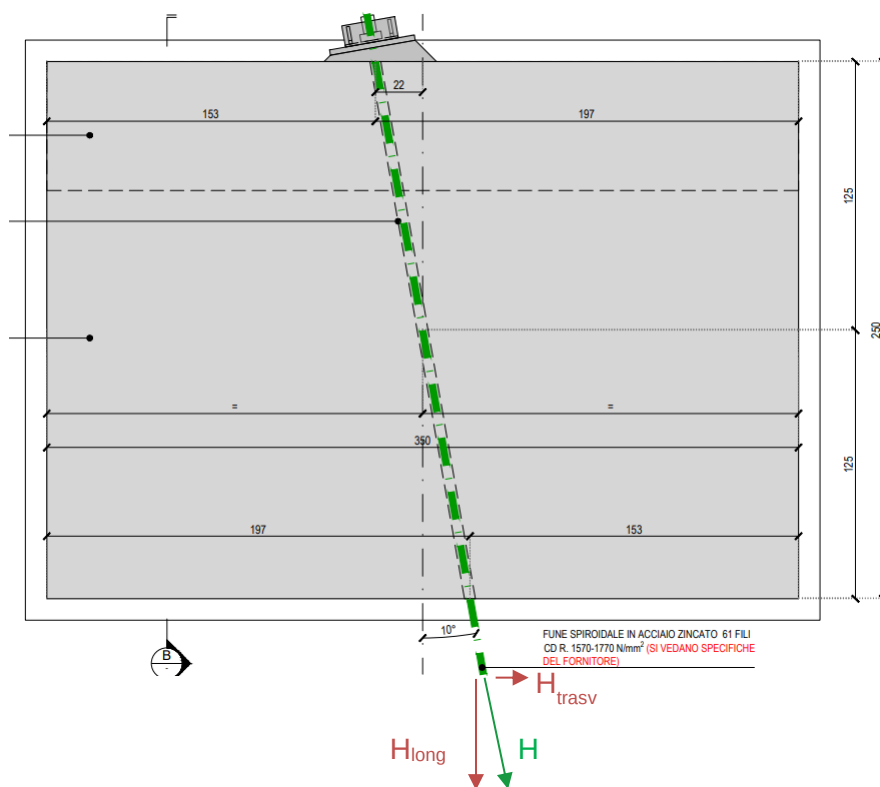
Inclinazione della fune rispetto alla direzione trasversale del plinto
